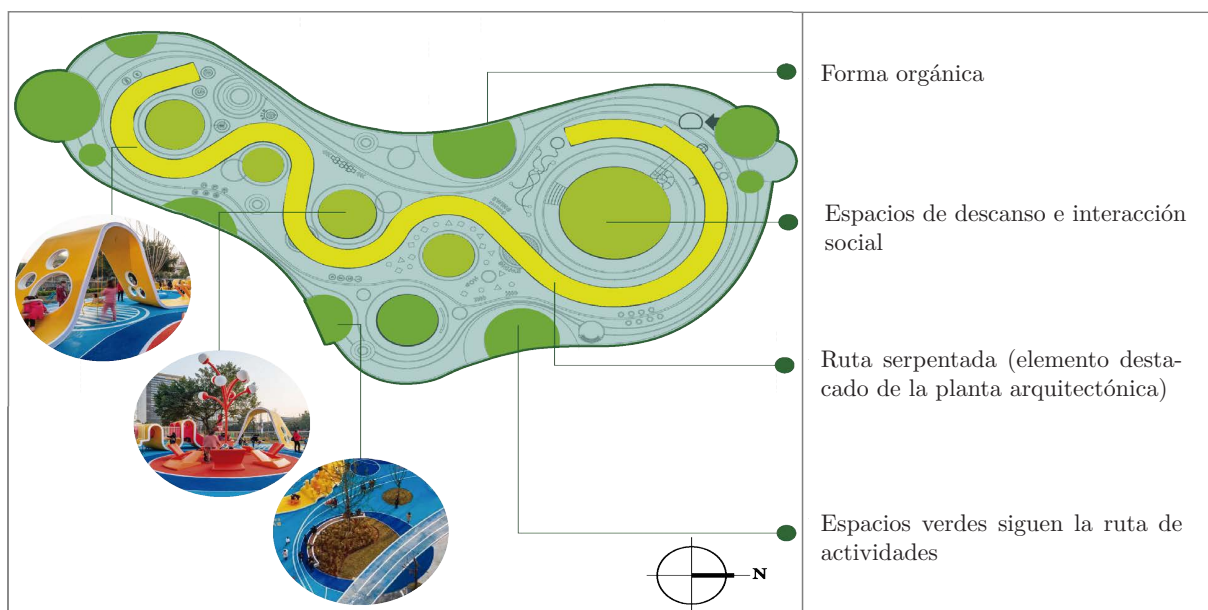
Esquema de planta arquitectónica. Fuente: [100architects \(2021\)](#).Elaboración: Propia.
